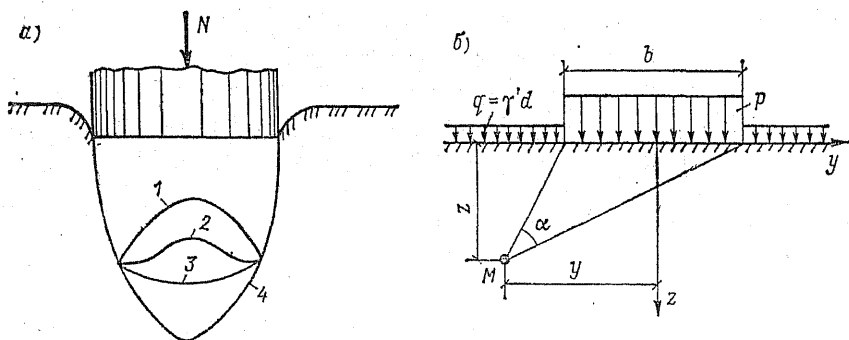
Схема изменения формы эпюры противодействия грунта по подошве жесткого круглого штампа (а) и схема полосовой нагрузки (б)
